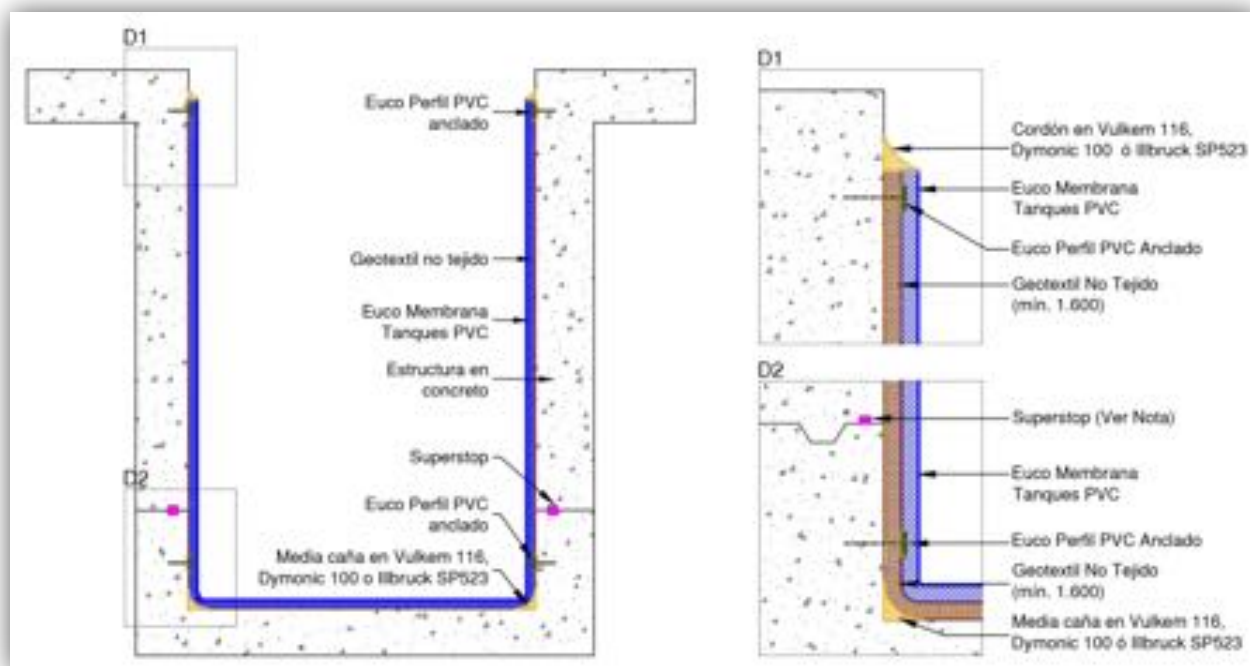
Detalles constructivos instalación membrana a base de PVC plastificado y reforzado con armadura de poliéster, imagen de fuente productos Toxement.
